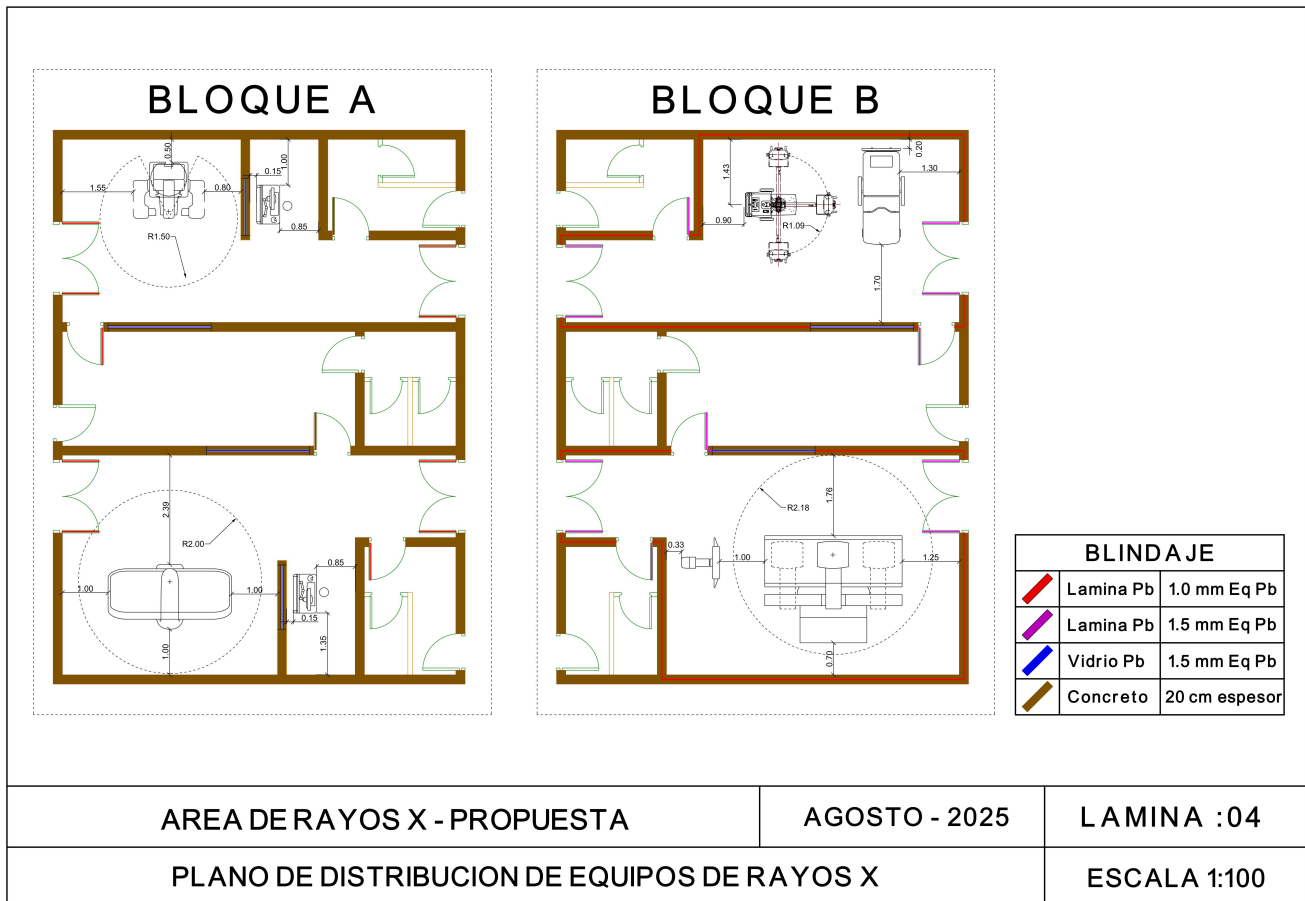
Plano de blindaje de distribución equipos y especificación de blindaje, autoría propia.
